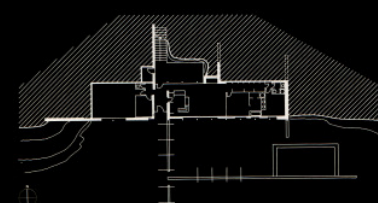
/ 10 – Vista e Planta de uma casa ecológica
